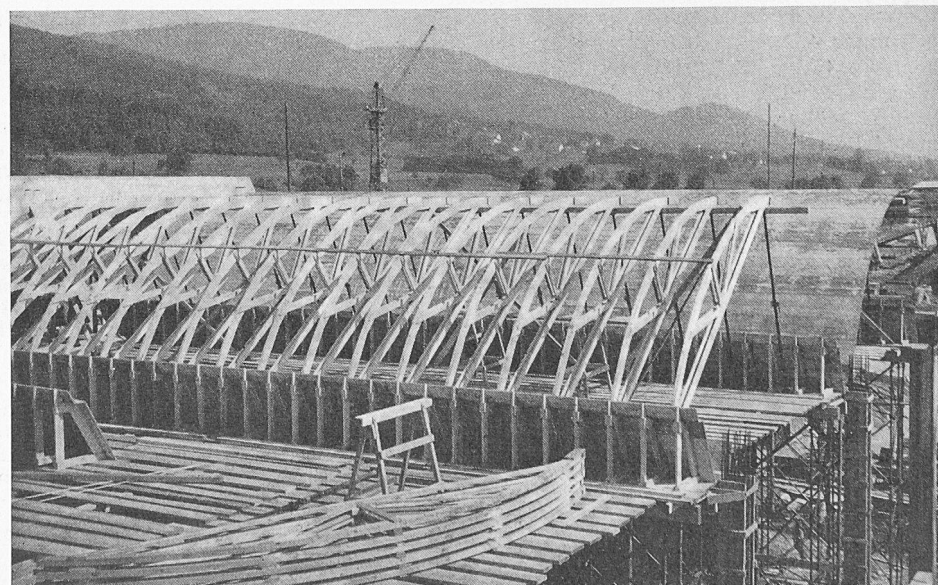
Aufbau der Schalung: Leichte Fachwerkbinder auf Stahlrohrgerüsten
